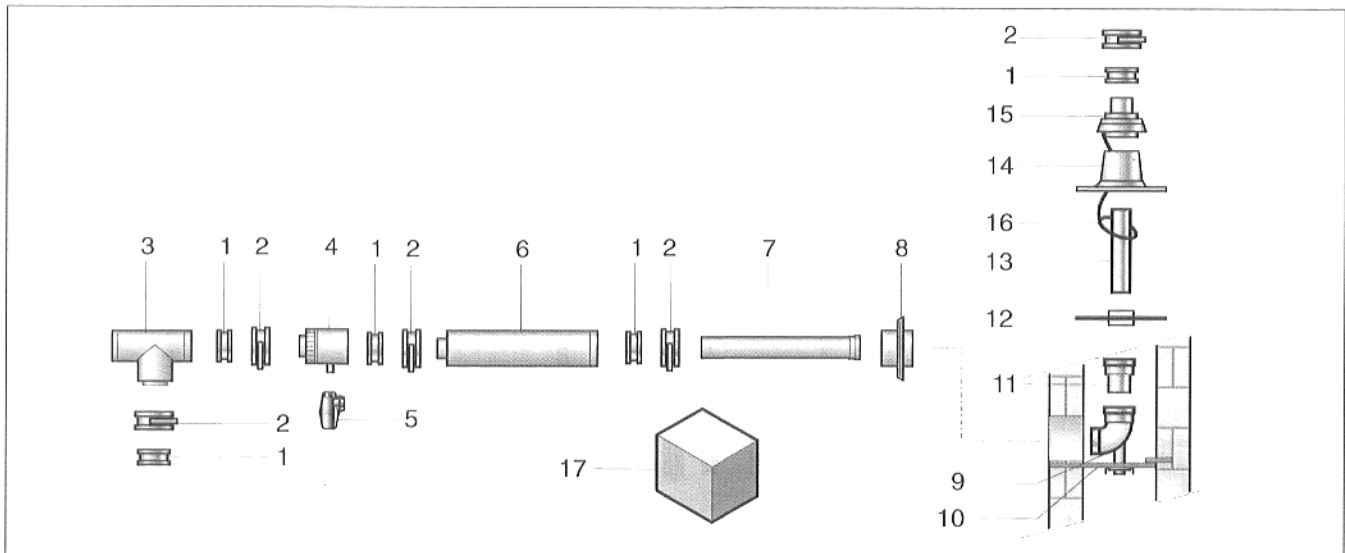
Lieferumfang Grundbausatz GA-K für U104 WG/WKG, Abgasführung mit Aluminium-Rohren
